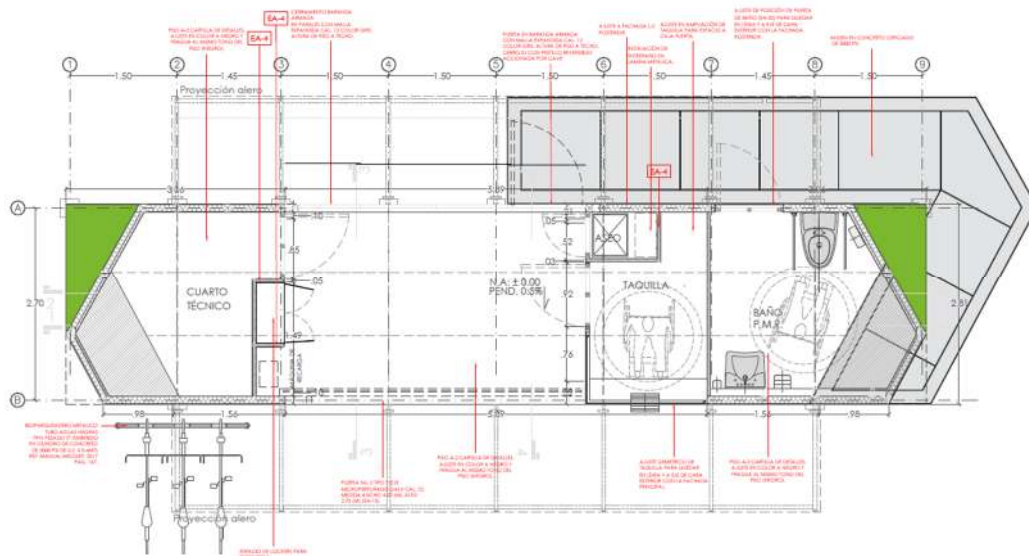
Corte en Planta Taquilla con ajuste taquillera, baño y lavatra peros. Plano 6. A-101 PLANTA 1ER PISO-CUBIERTA.dwg.
